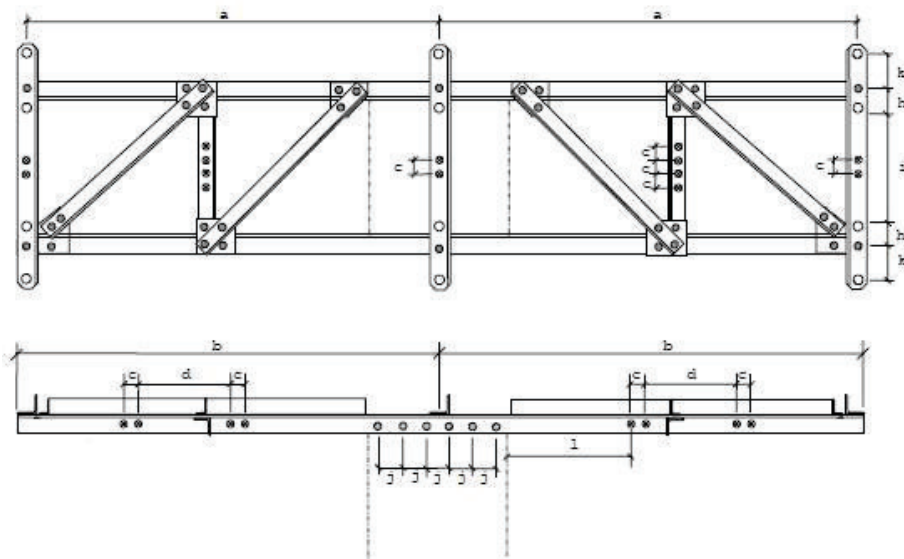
Cruceta recta tipo RC2 para apoyos metálicos
